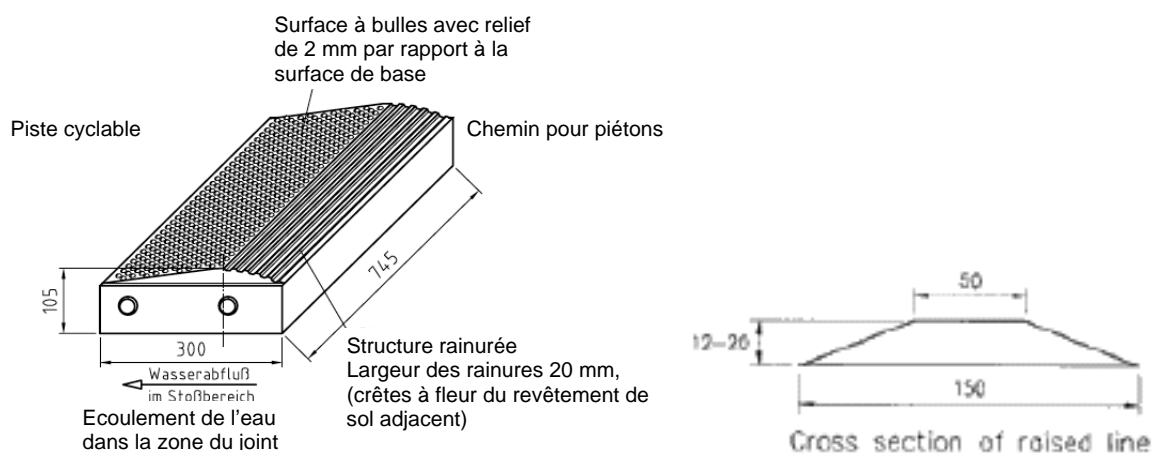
Plaque pour piste cyclable RAILBETON /Tactile paving UK, Central delineator strip
